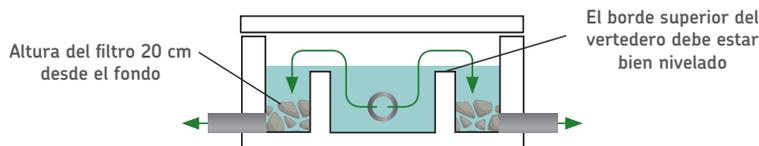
Detalles constructivos de la cámara-filtro de distribución.
